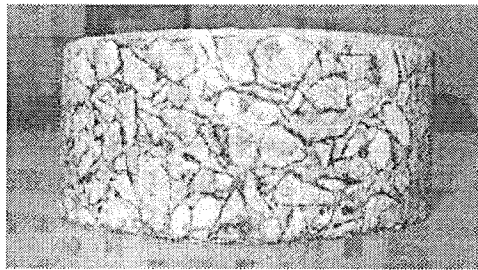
Carote retirado de uma laje de mistura betuminosa preenchida com calda
